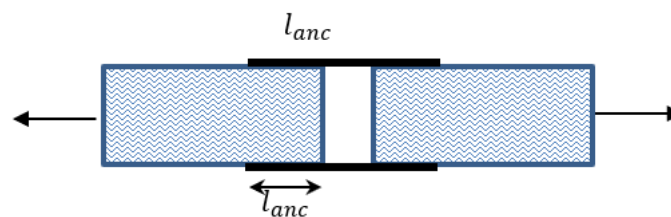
Essai de résistance au cisaillement du composite sur le support béton, de part et d'autre d'une fissure
